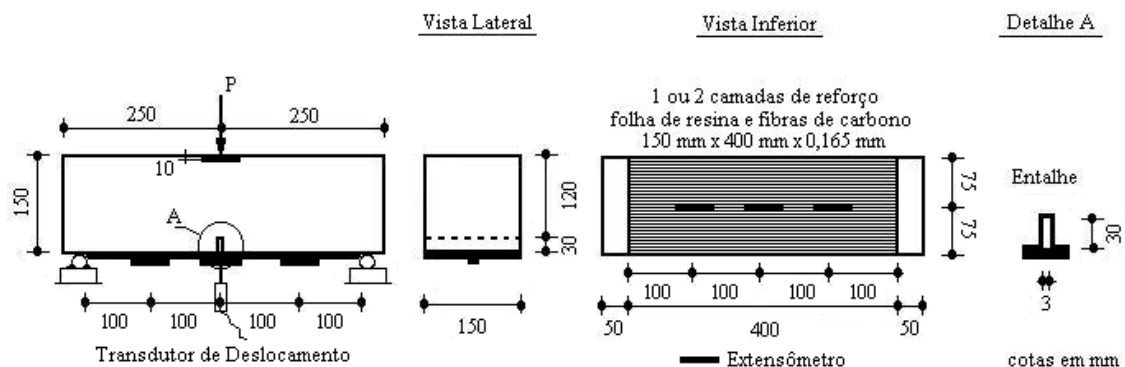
Instrumentação Externa das Vigotas de Concreto Simples
